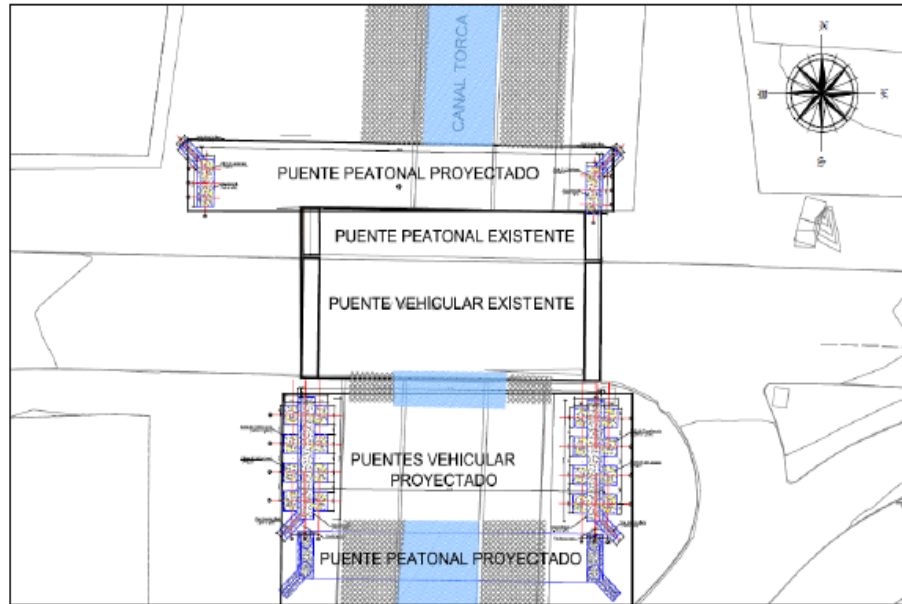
Plano en planta de los tres puentes proyectados sobre el canal Torca.
